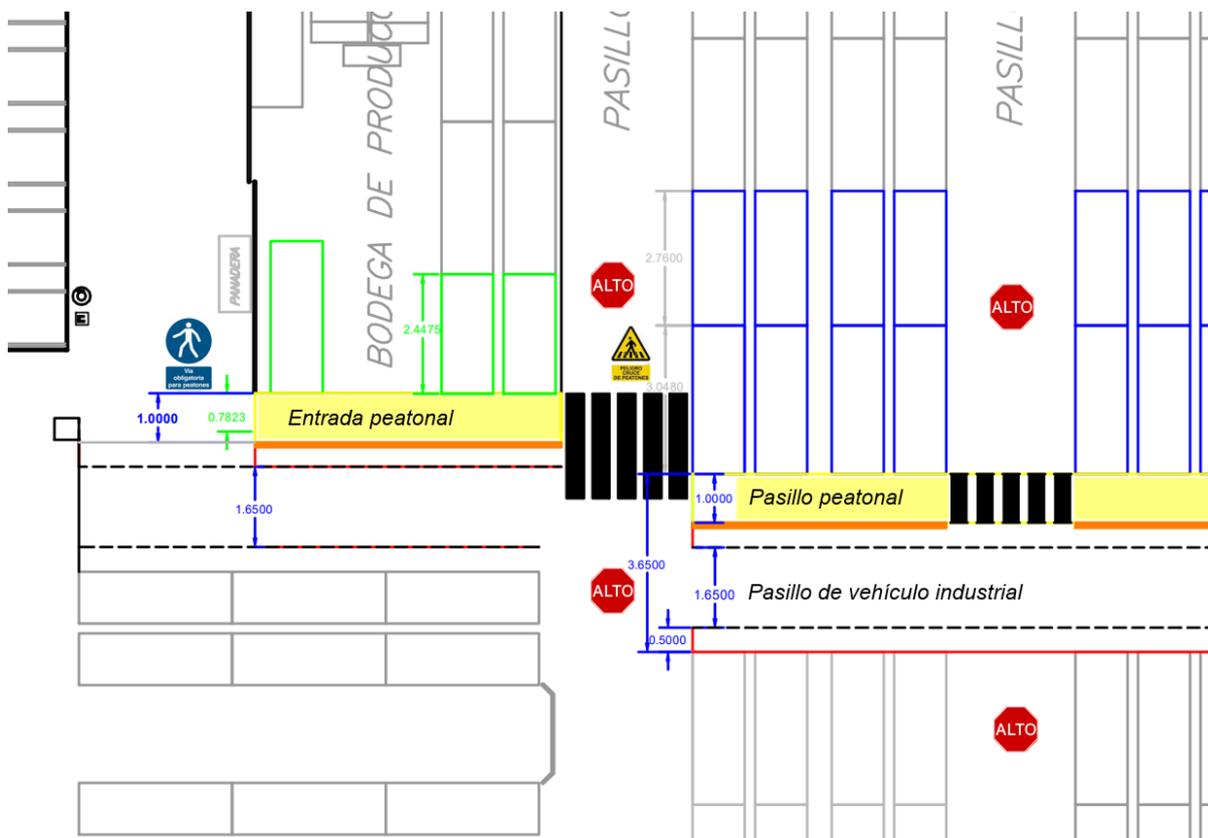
Diseño general de la Alternativa 1 (ver plano completo en el Apéndice 14)
